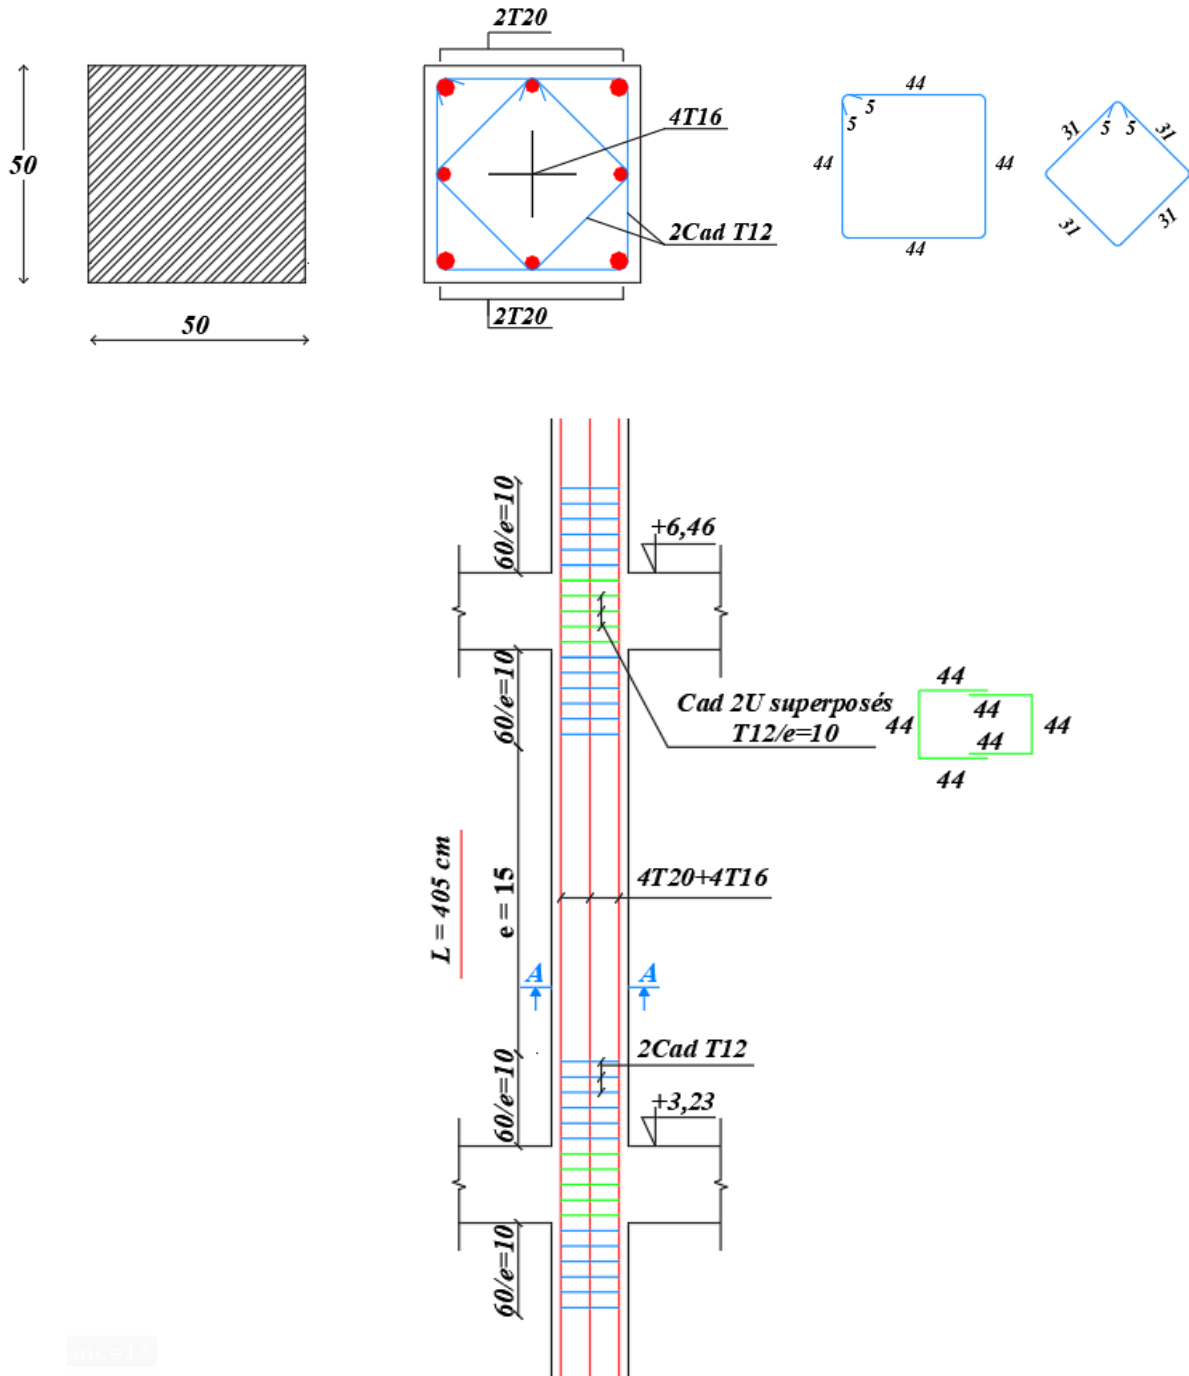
Schéma de ferrailage des poteaux (50x50)
